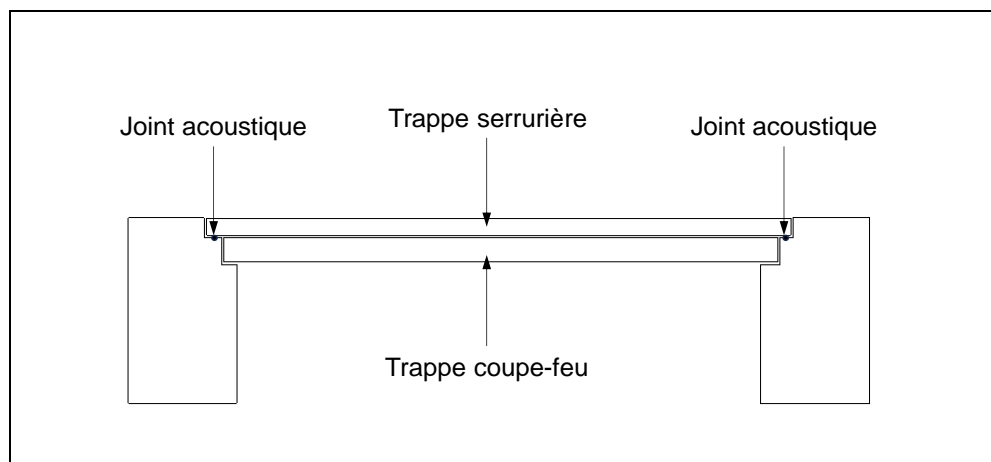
Coupe de principe avec mise en œuvre d'une trappe serrurière
